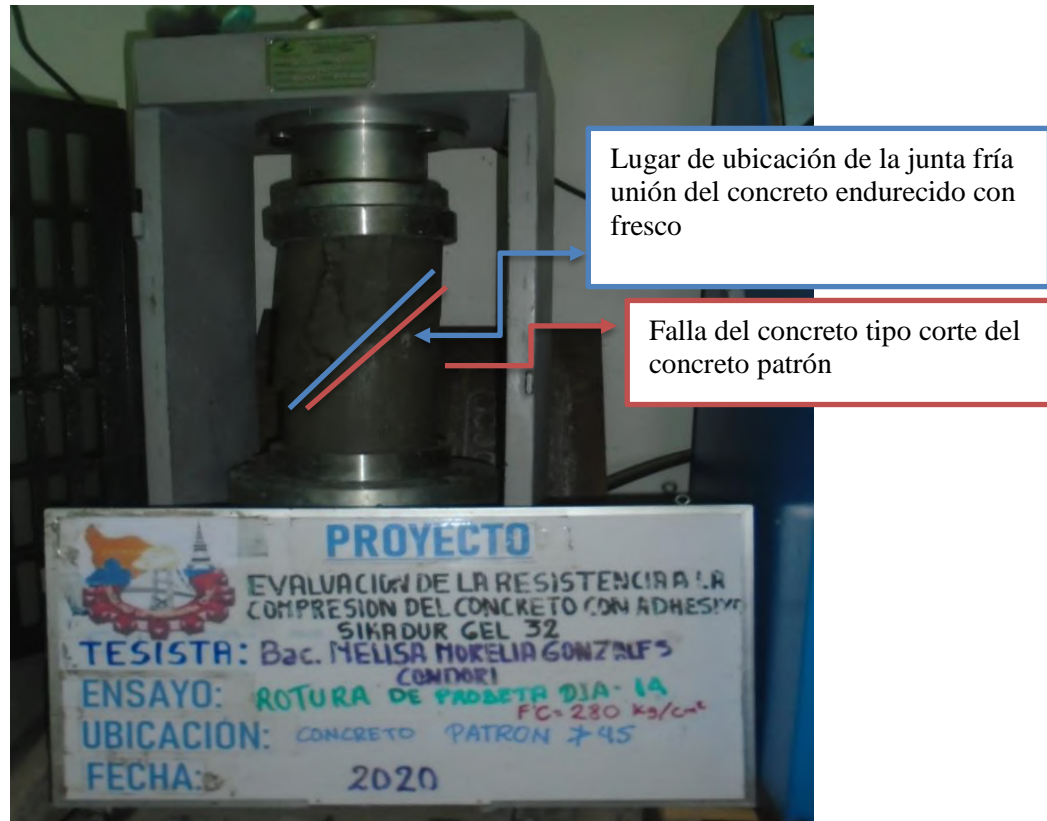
Falla tipo corte en briquetas de concreto patrón
